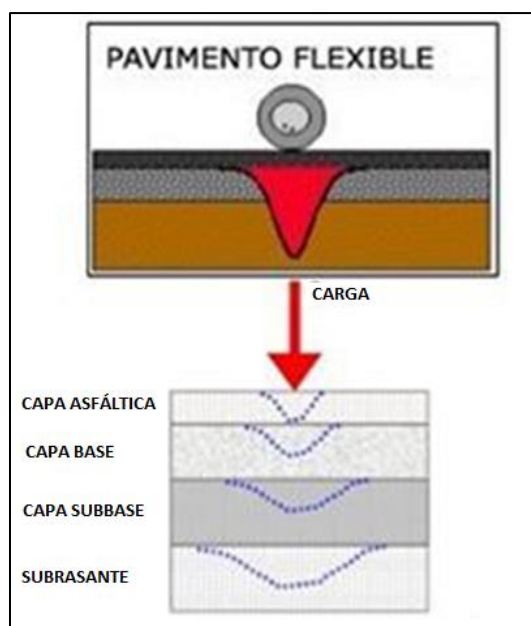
Pavimento Flexible - (Montejo Fonseca, 2002)
